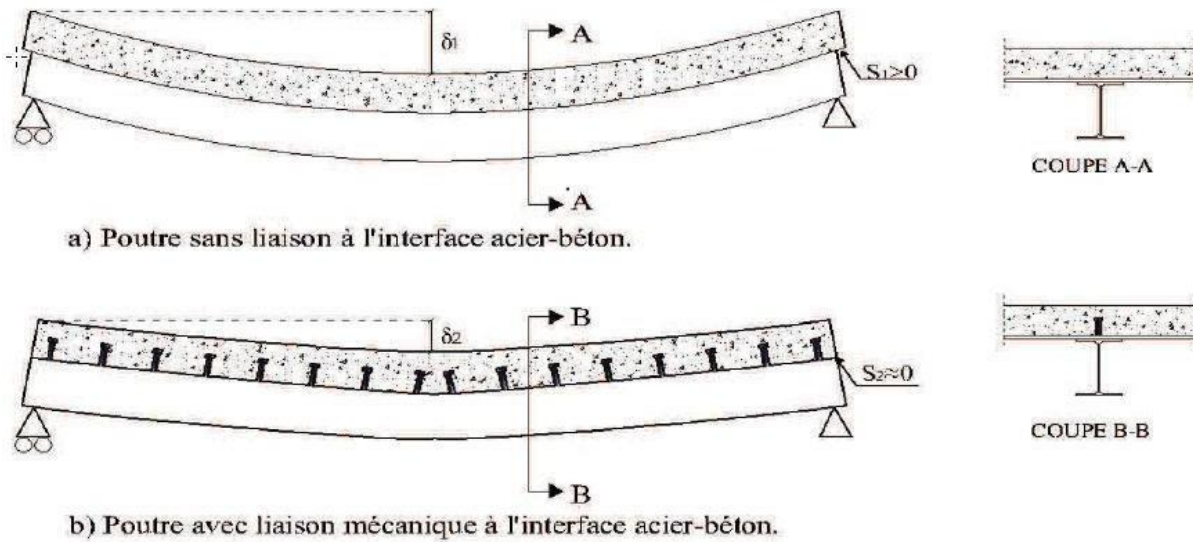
principe de fonctionnement de poutre mixte fléchis.
